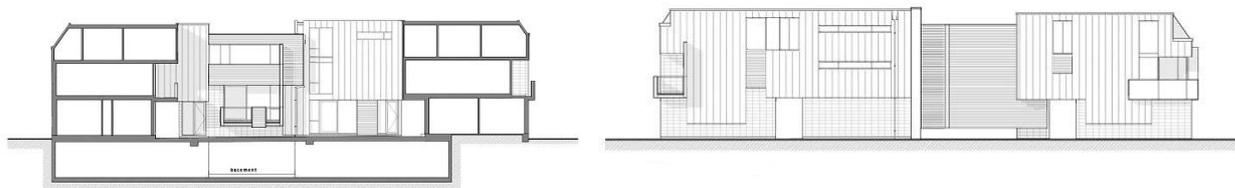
Северный фасад из внутреннего двора и фасад со стороны улицы Солсбери.
